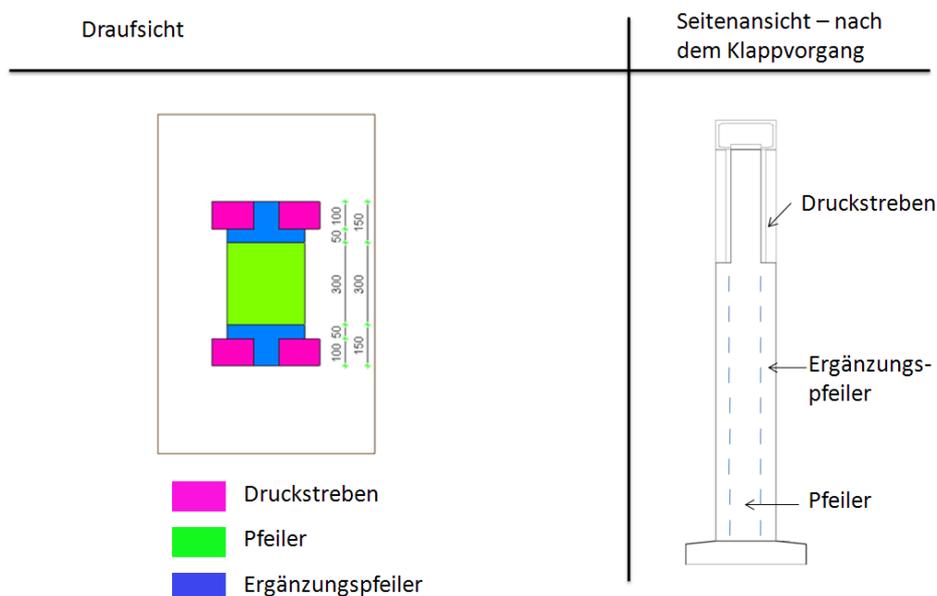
Brückenteile nach dem Klappvorgang mit Ergänzungspfeiler
